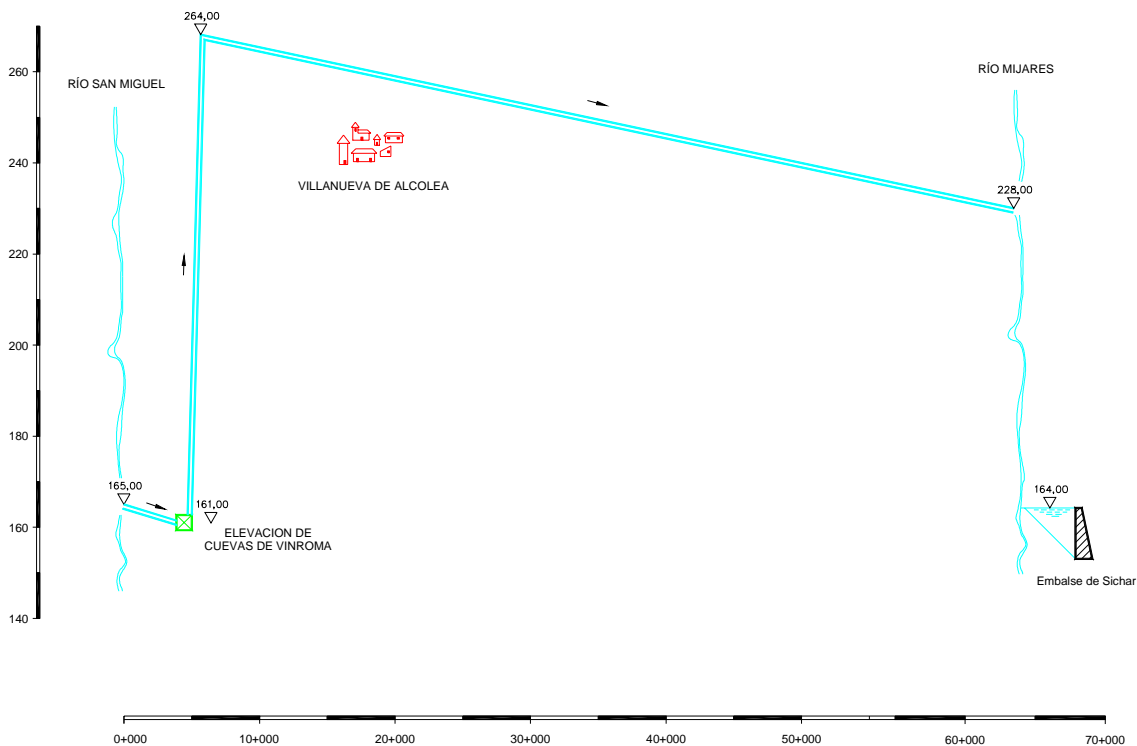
Conducción Castellón Norte - Mijares. Esquema en alzado.
